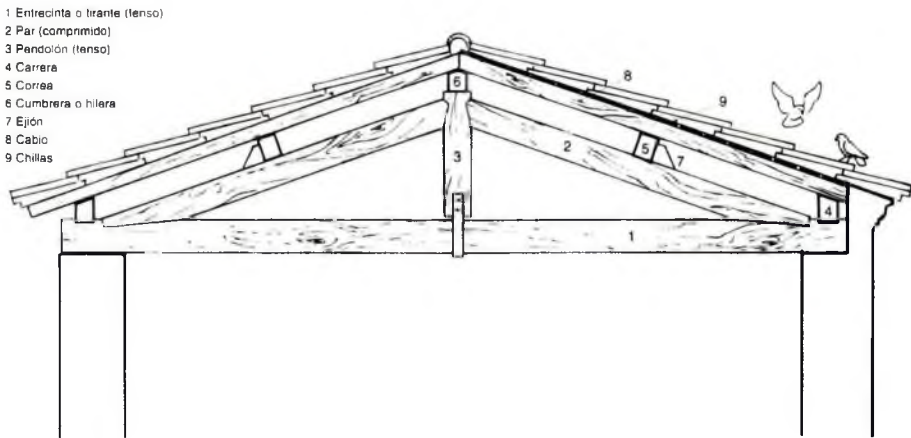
Reconstrucción del armazón de madera de una cubierta (de J. P. Adam).
